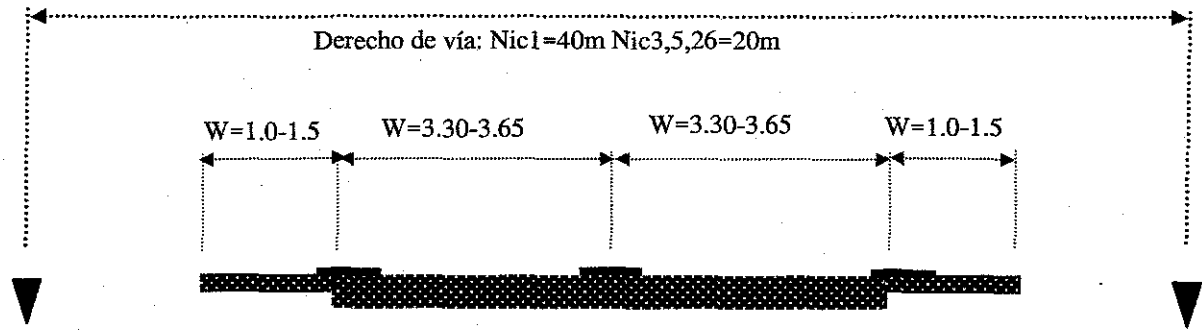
Sección Típica Transversal Estándar y Derecho de Vía
